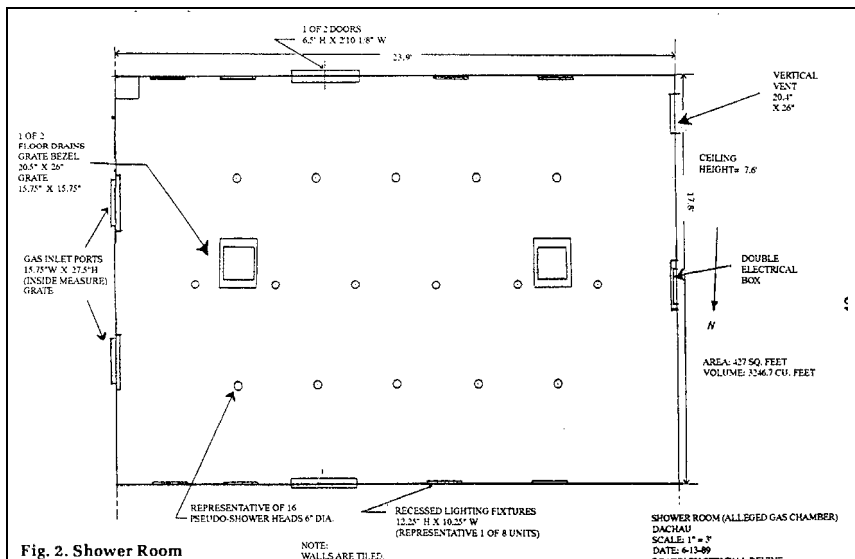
Grundriss des Duschraums in der "Baracke X" des KL Dachau.
